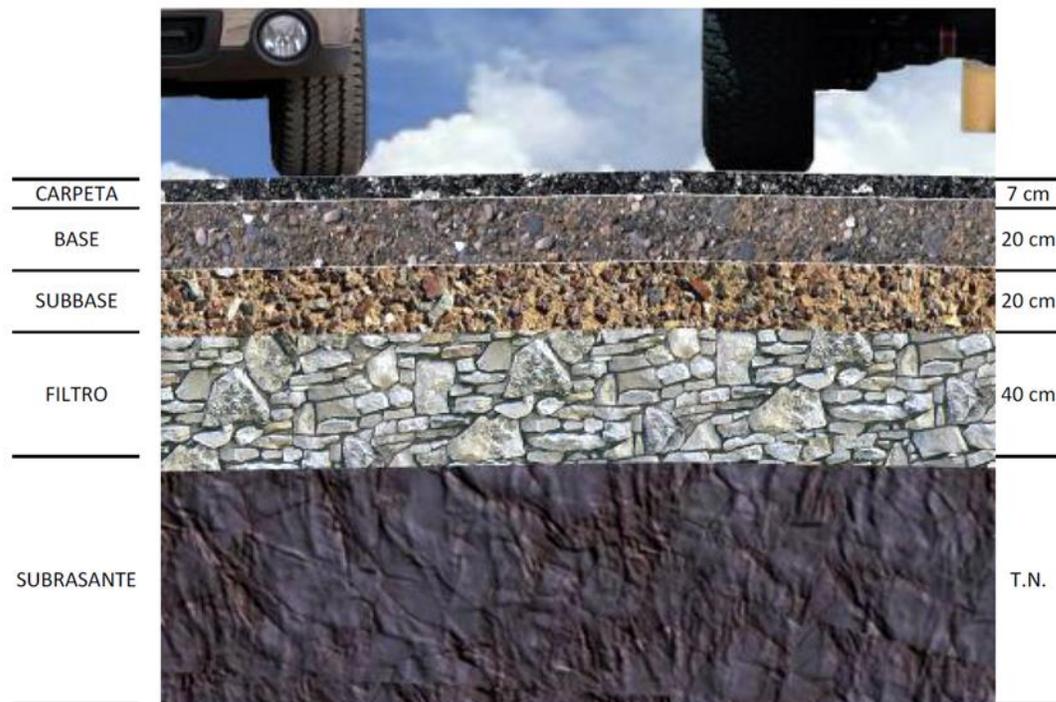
Sección transversal del pavimento. (CICC, 2013).
